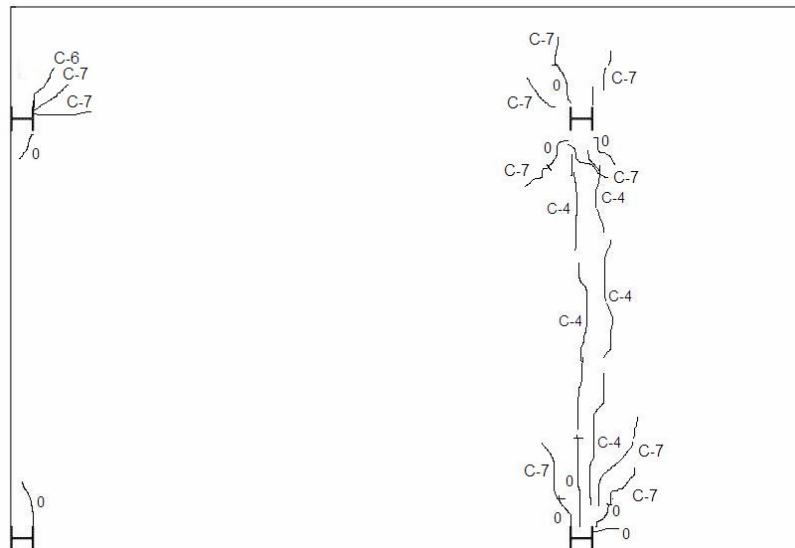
Esquema de fissuração da laje após as etapas de carregamentos distribuídos
